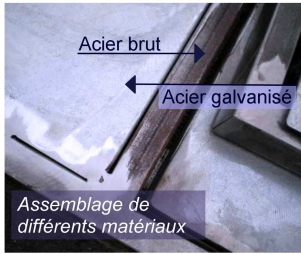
DEFAUTS D'ASSEMBLAGE
